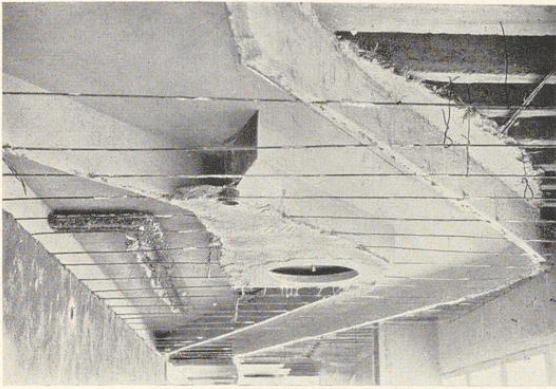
Warmluftkanal mit Schöpfklappe und Austrittsöffnung, Wände und Decke fertig verputzt. Die Rabitzdecke bildet zugleich den Kanalboden
